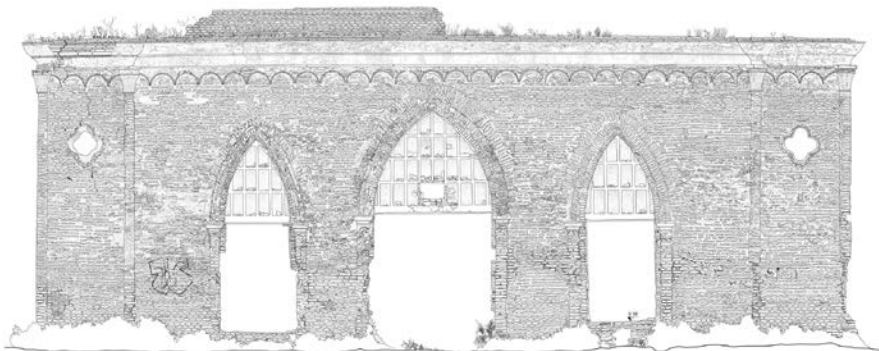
Levantamiento del estado actual de la fachada norte del Molino (C. Palomba)
